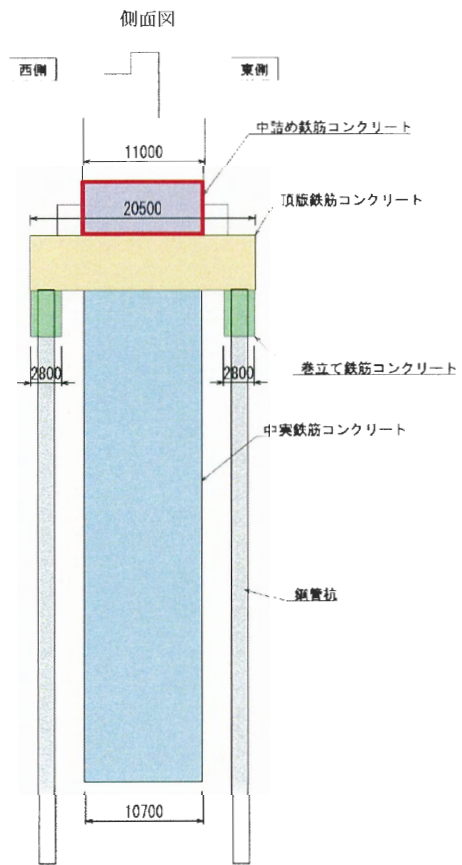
中詰め鉄筋コンクリートの配筋図
